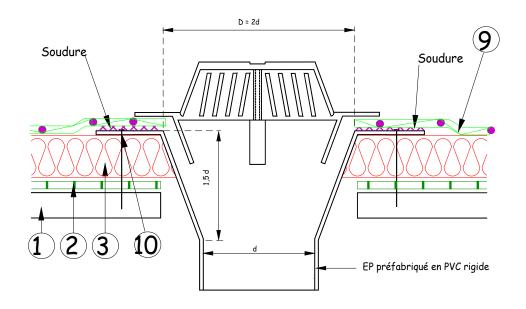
Entrée d'eau pluviale préfabriquée en PVC
